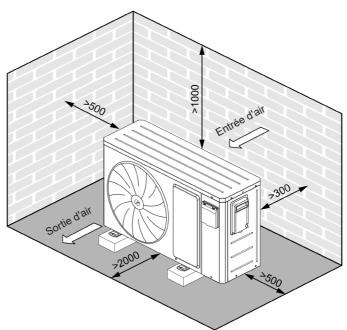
Dimensions de l'espace d'installation de l'appareil
